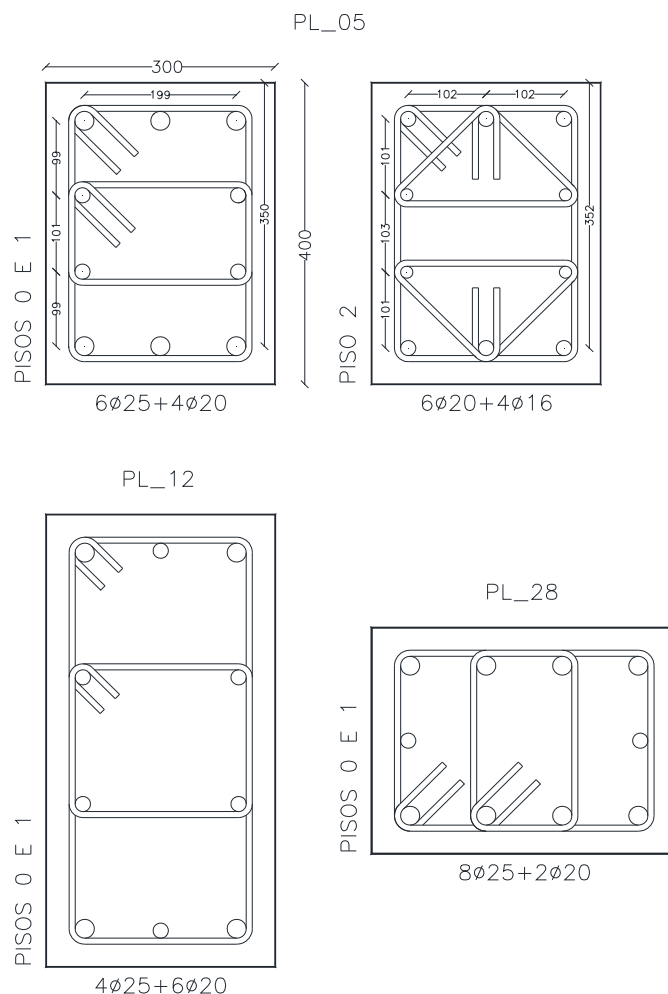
Pormenor dos pilares-exemplo nas zonas críticas (dimensões em mm)
